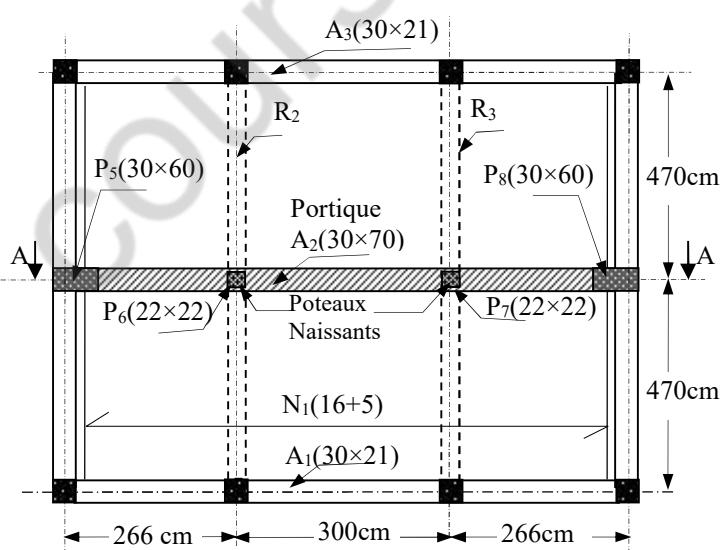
Plan de coffrage du plancher 1^{er} étage
